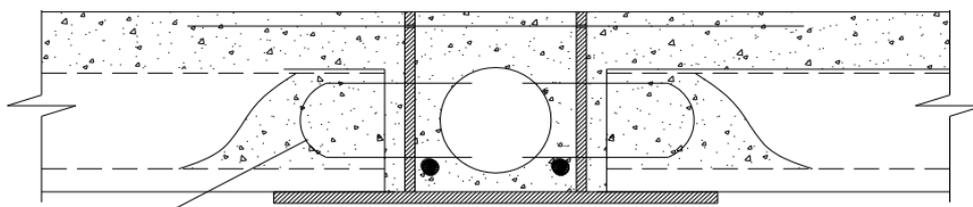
Сборно-монолитное перекрытие с пустотно-ребристыми плитами
